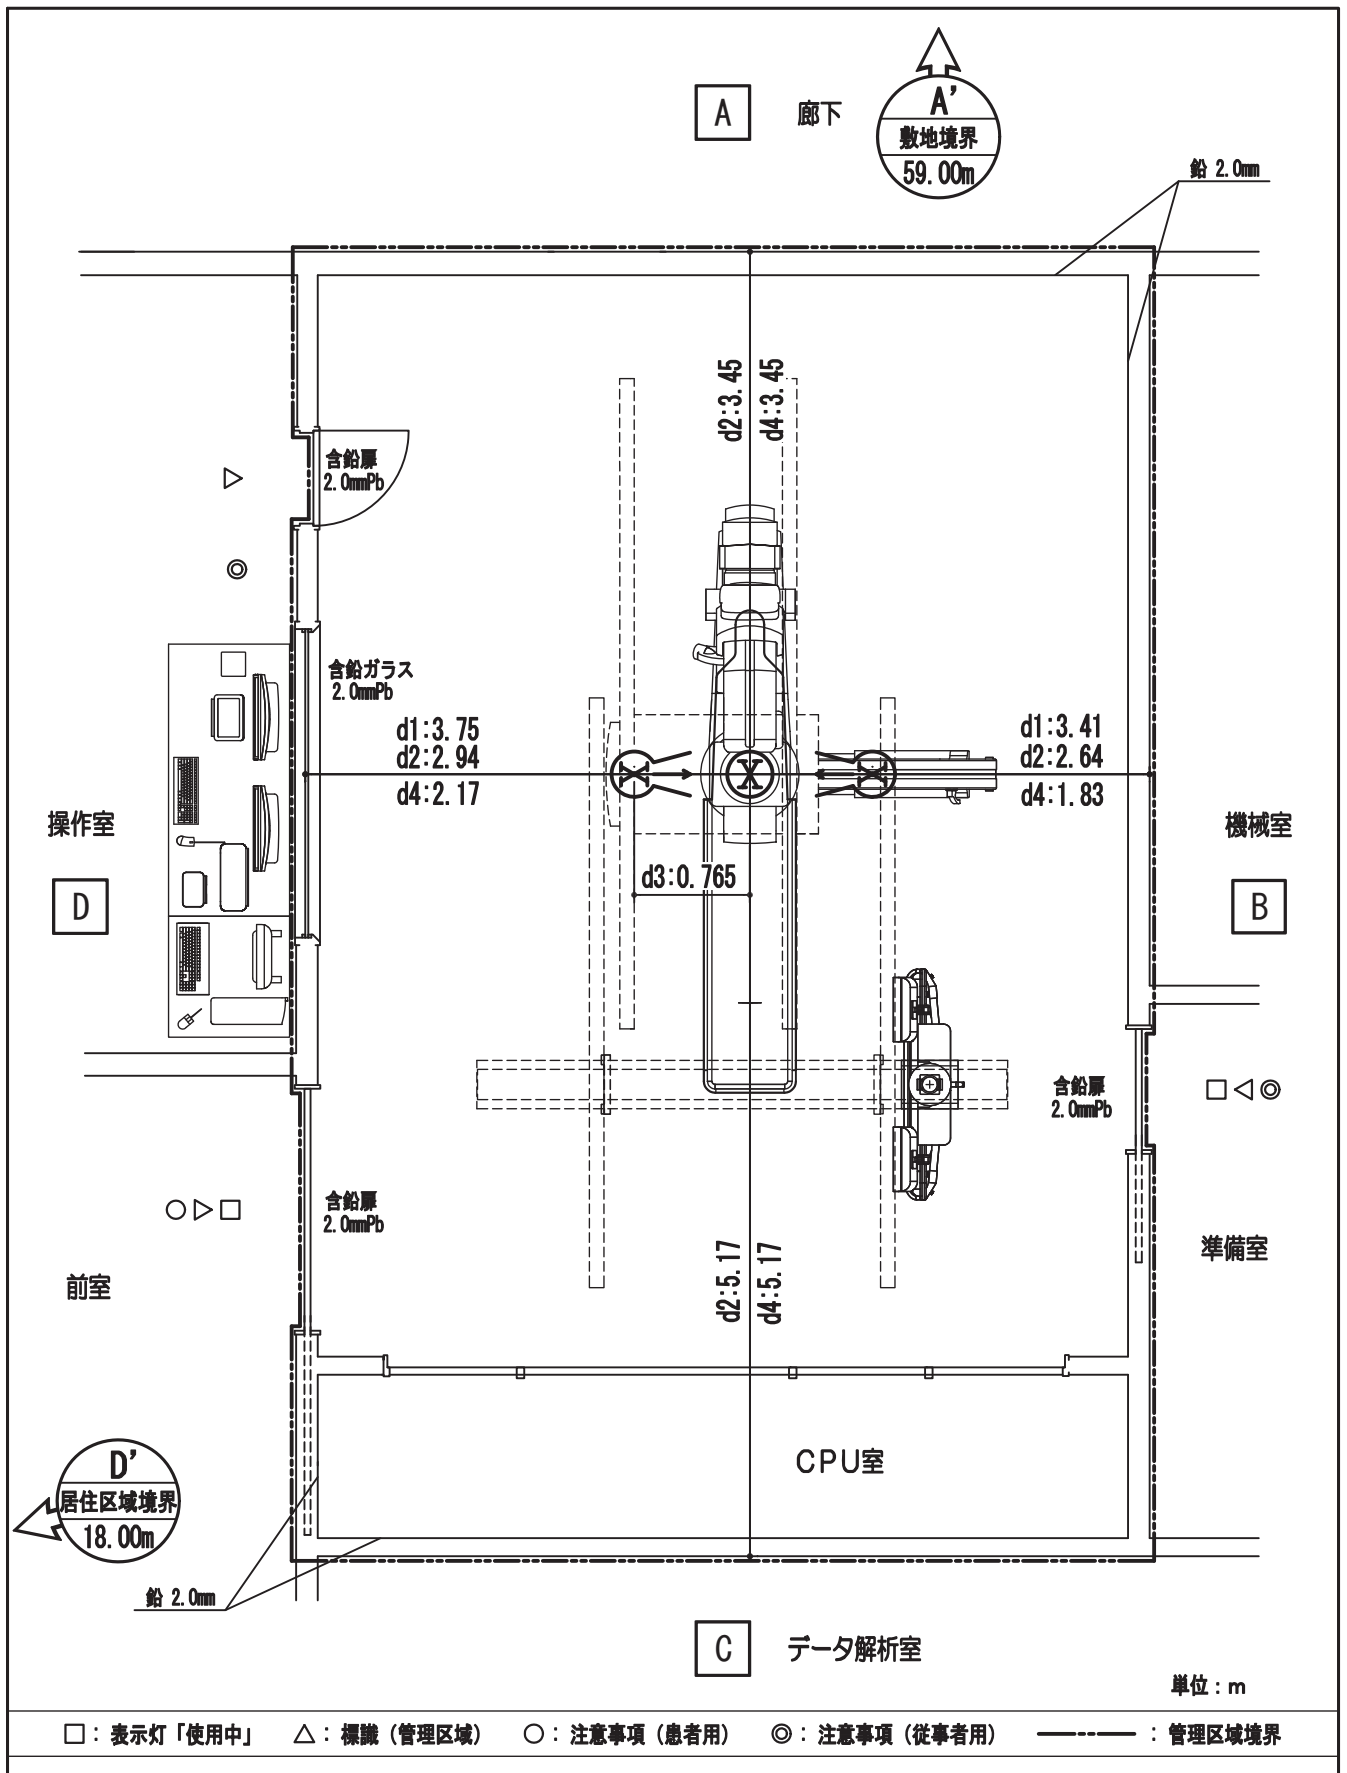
循環器用X線診断装置 透視・撮影 平面図
